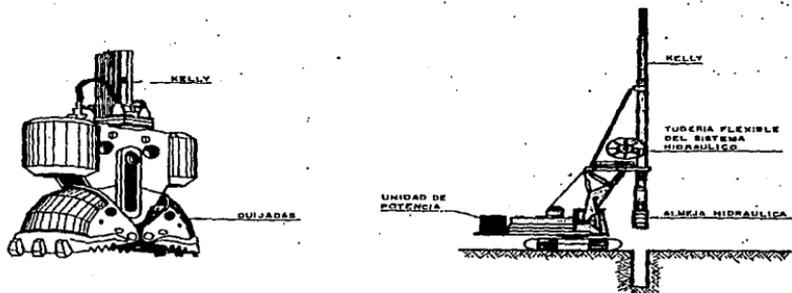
Almeja hidráulica para excavaciones oblongas y almeja hidráulica guiada, montada sobre equipo de excavación
